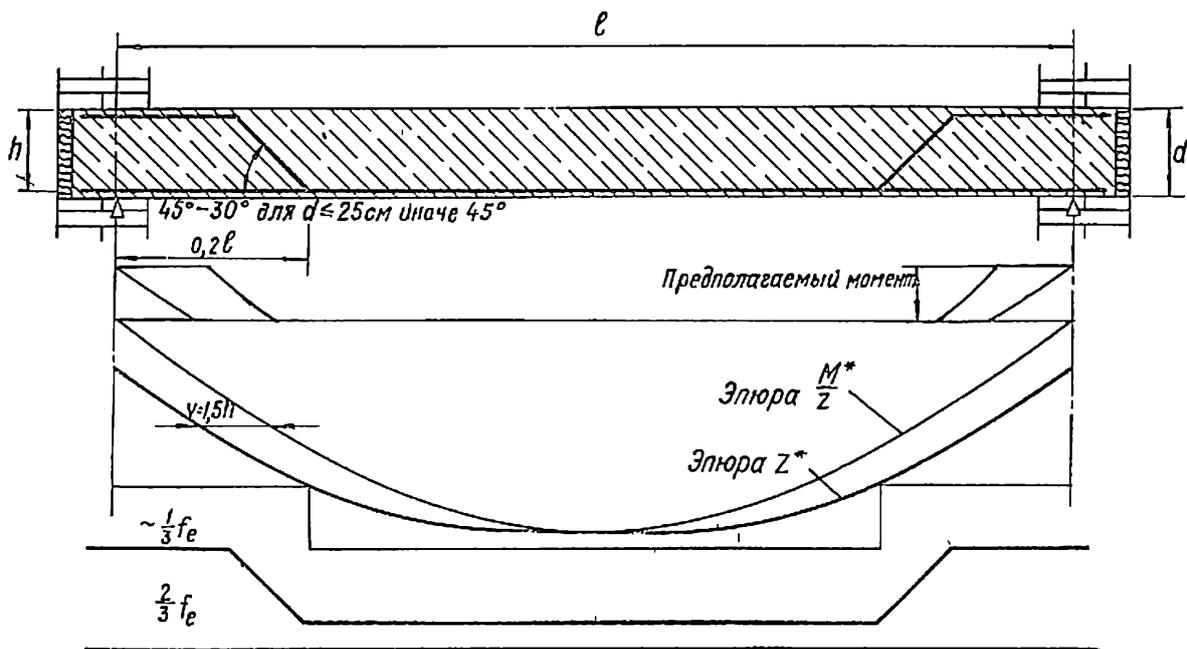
3. Восприятие небольших опорных моментов путем отгиба стержней пролетной арматуры
